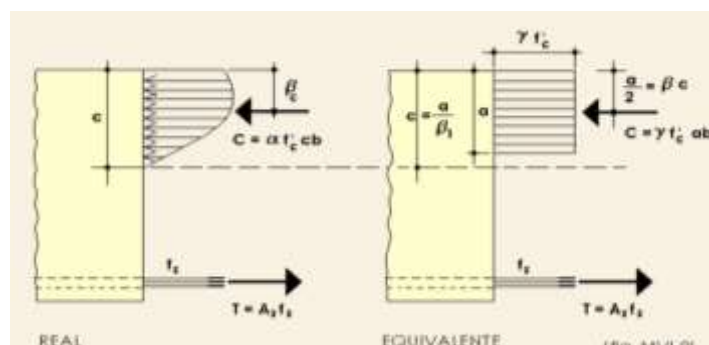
Deformaciones y esfuerzos en una sección rectangular de concreto armado.
